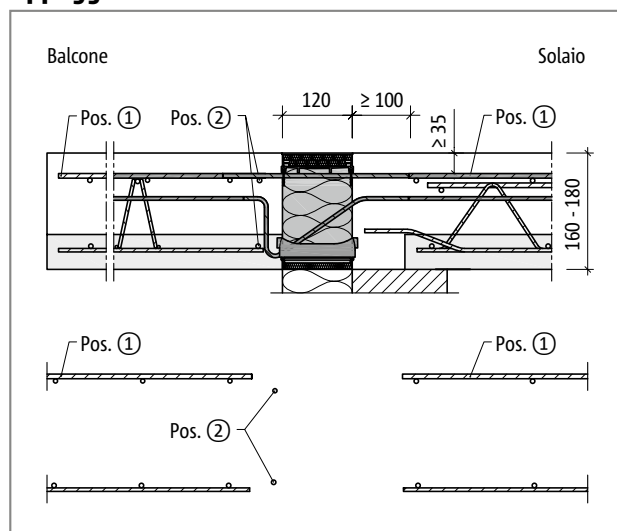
Schöck Isokorb® XT tipo KL-F: armatura in opera con spessore del balcone $h = 160 - 180$ mm
